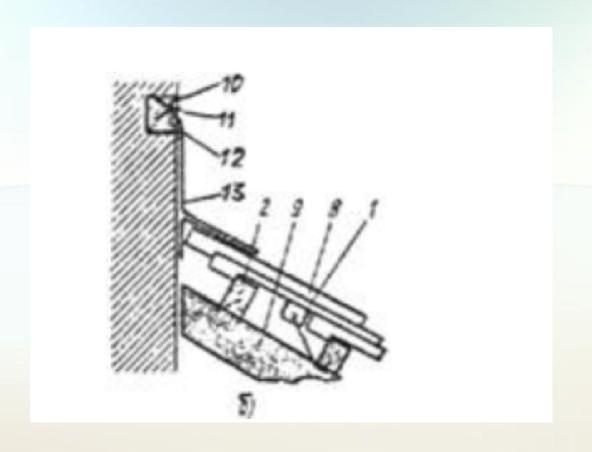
Примыкание кровли к стене: 10 - раствор; 11 - гвозди; 12 - рейка; 13 - фартук из кровельной стали
